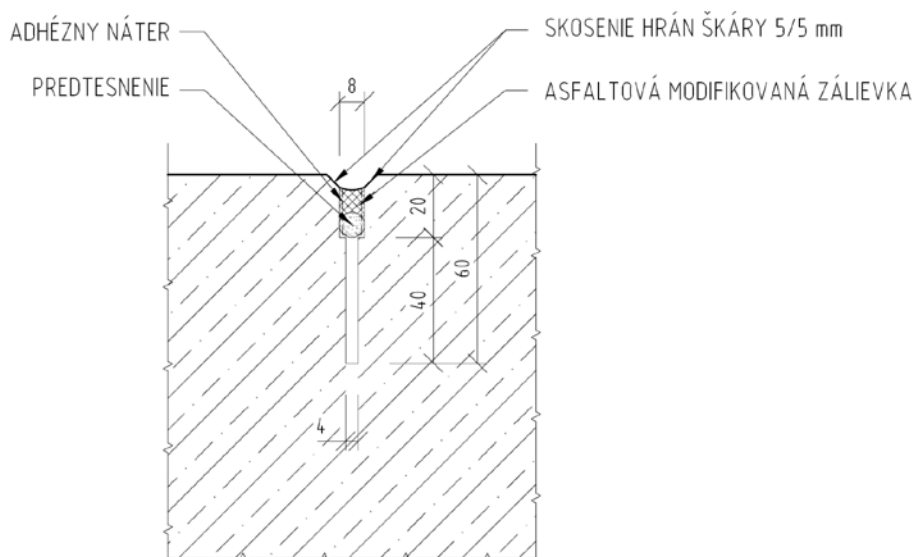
Detail tesnenia rezanej škára s klzným trňom
